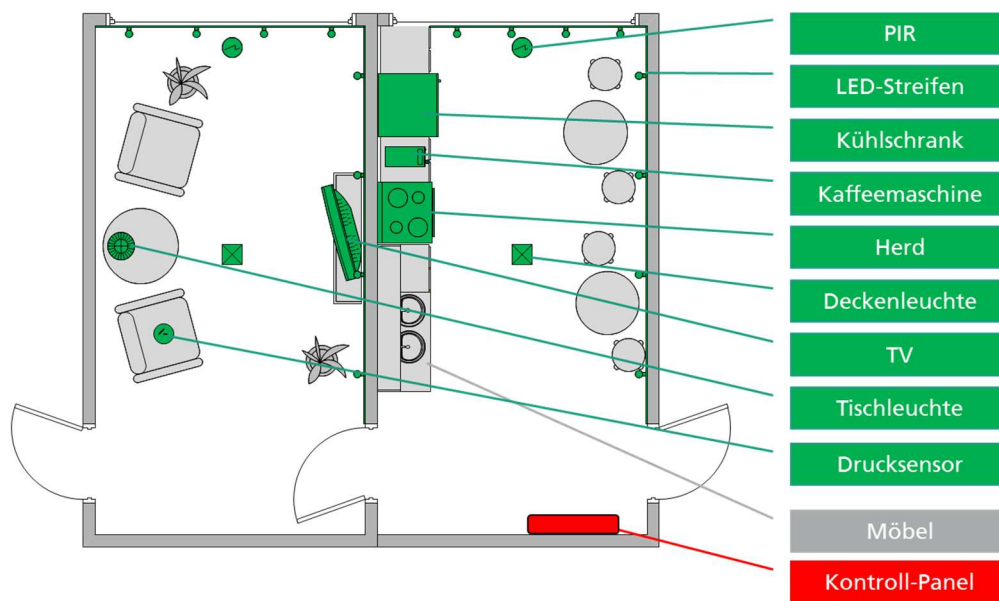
Grundriss und Ausstattung von ComTecFlat
